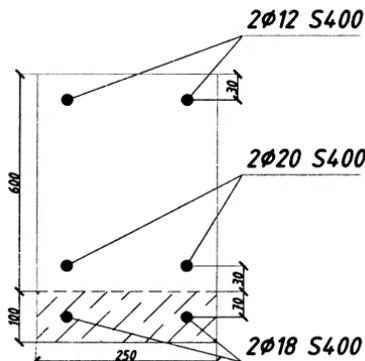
К расчету усиления растянутой зоны приваркой дополнительной арматуры
